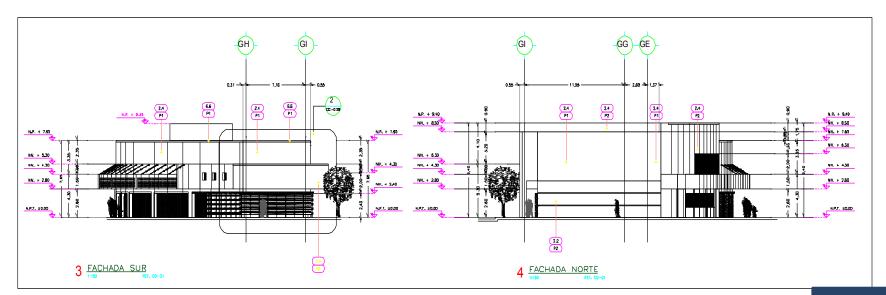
Fachadas Arquitectónicas del cuerpo "G", Referencia Plano: CPJ-CG- 03.DWG
